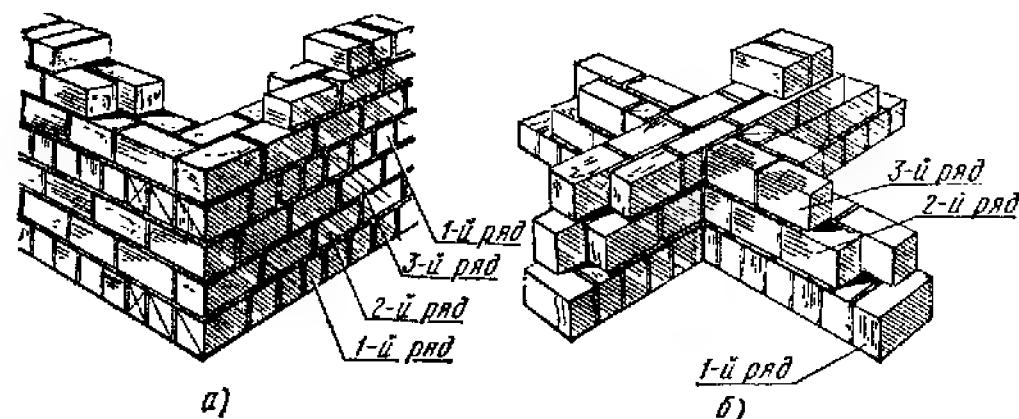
Трехрядная перевязка кладки из бетонных камней: а — угол кладки, б — пересечение стен
